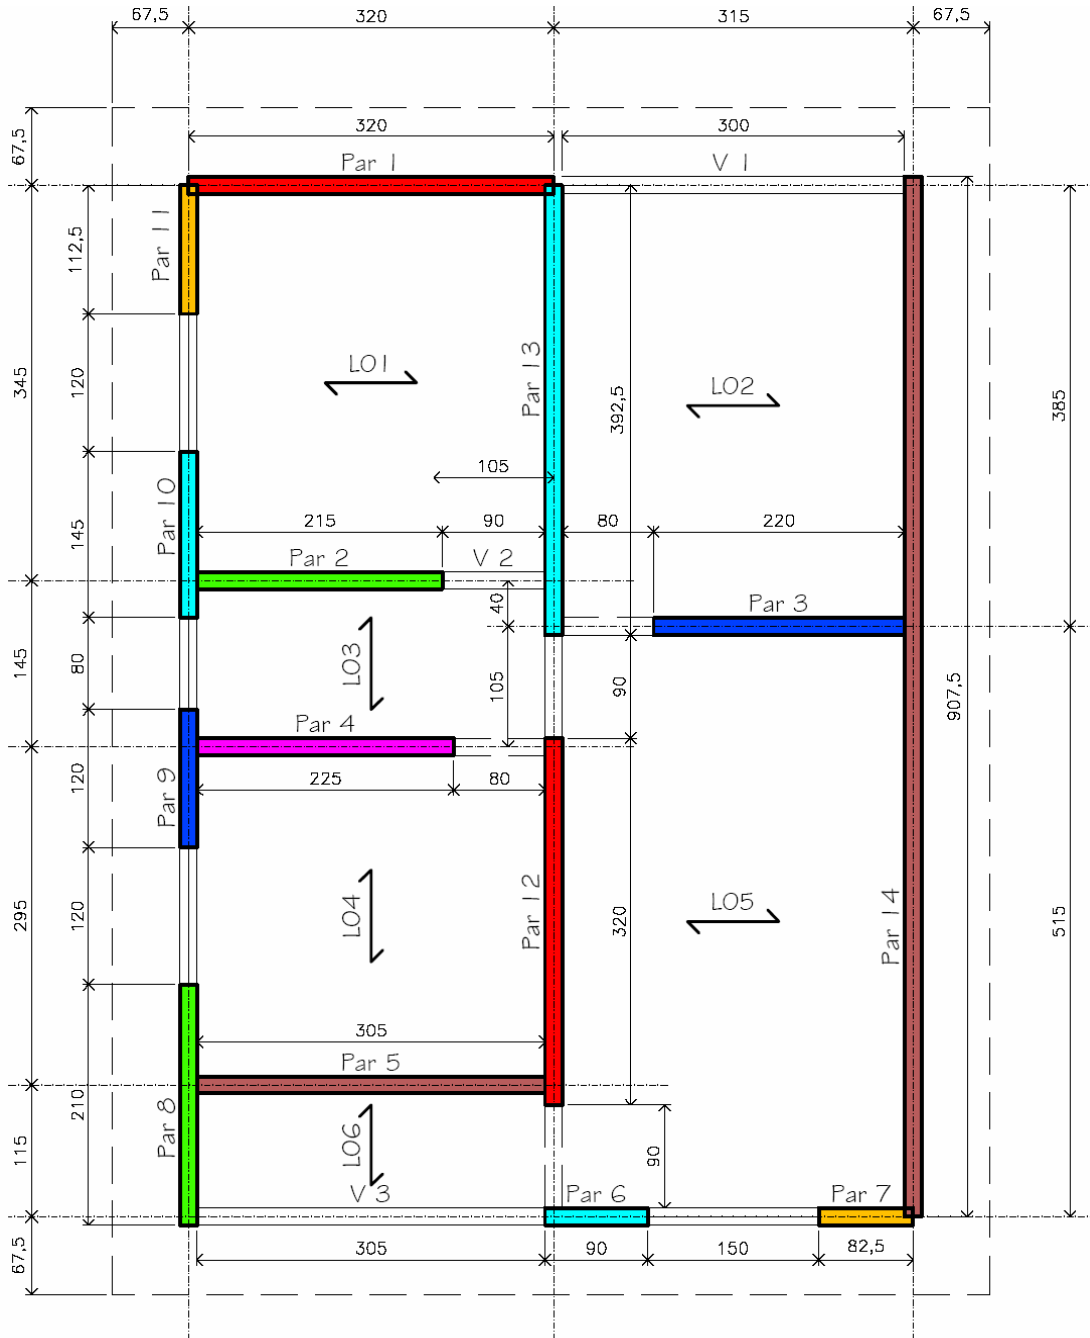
Estrutura do Exemplo 1: proposta 1
